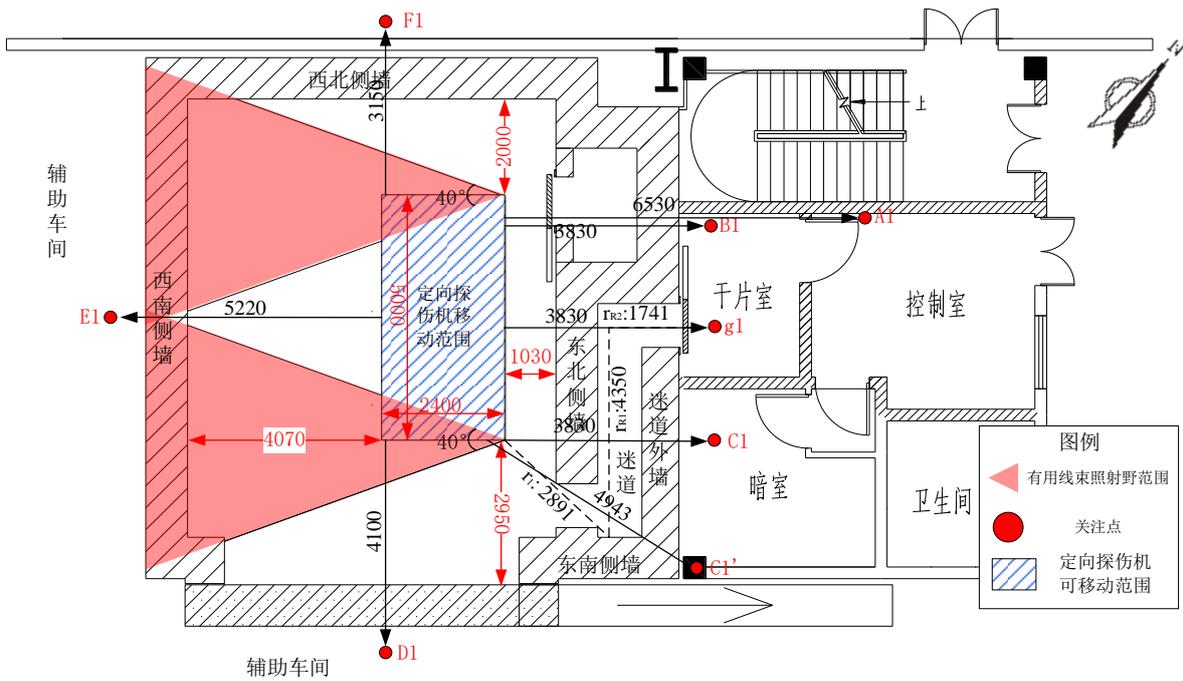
探伤室定向探伤机关注点位示意图（平面图）
